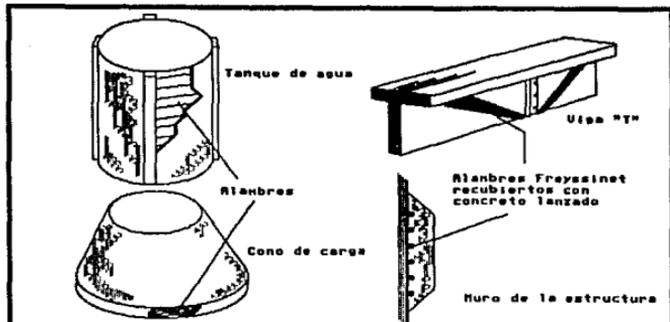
USO DEL CONCRETO LANZADO CON SISTEMA DE POSTENSADOS
